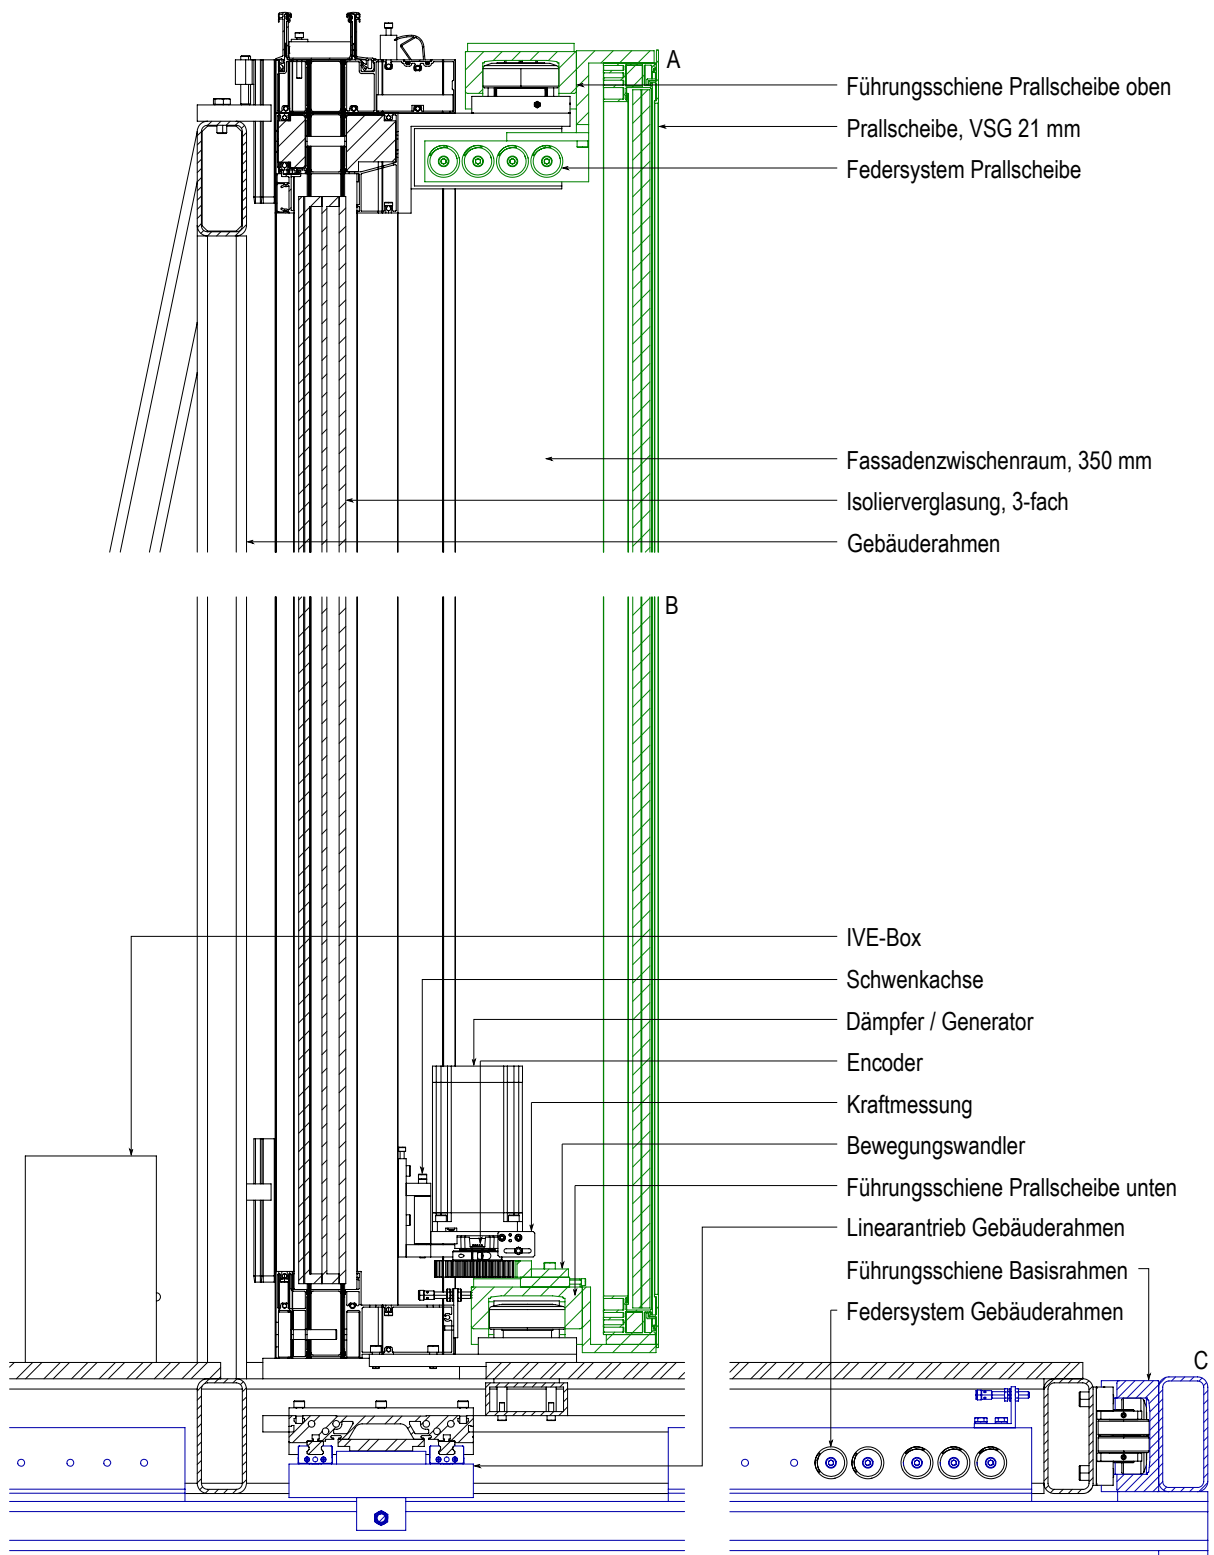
Detailschnitte der beweglichen Doppelfassade auf dem Prüfstand
